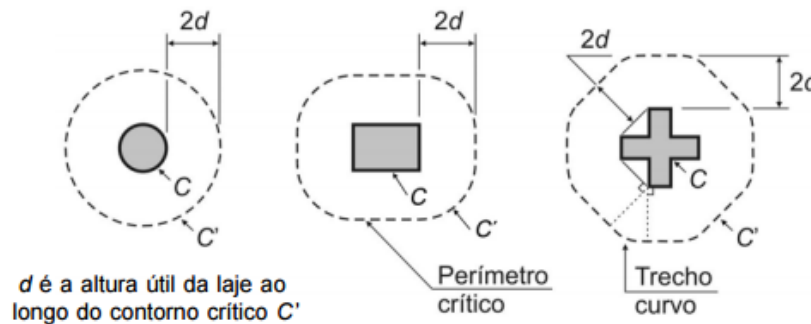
Perímetro crítico em pilares internos adotado pela norma brasileira NBR 6118
